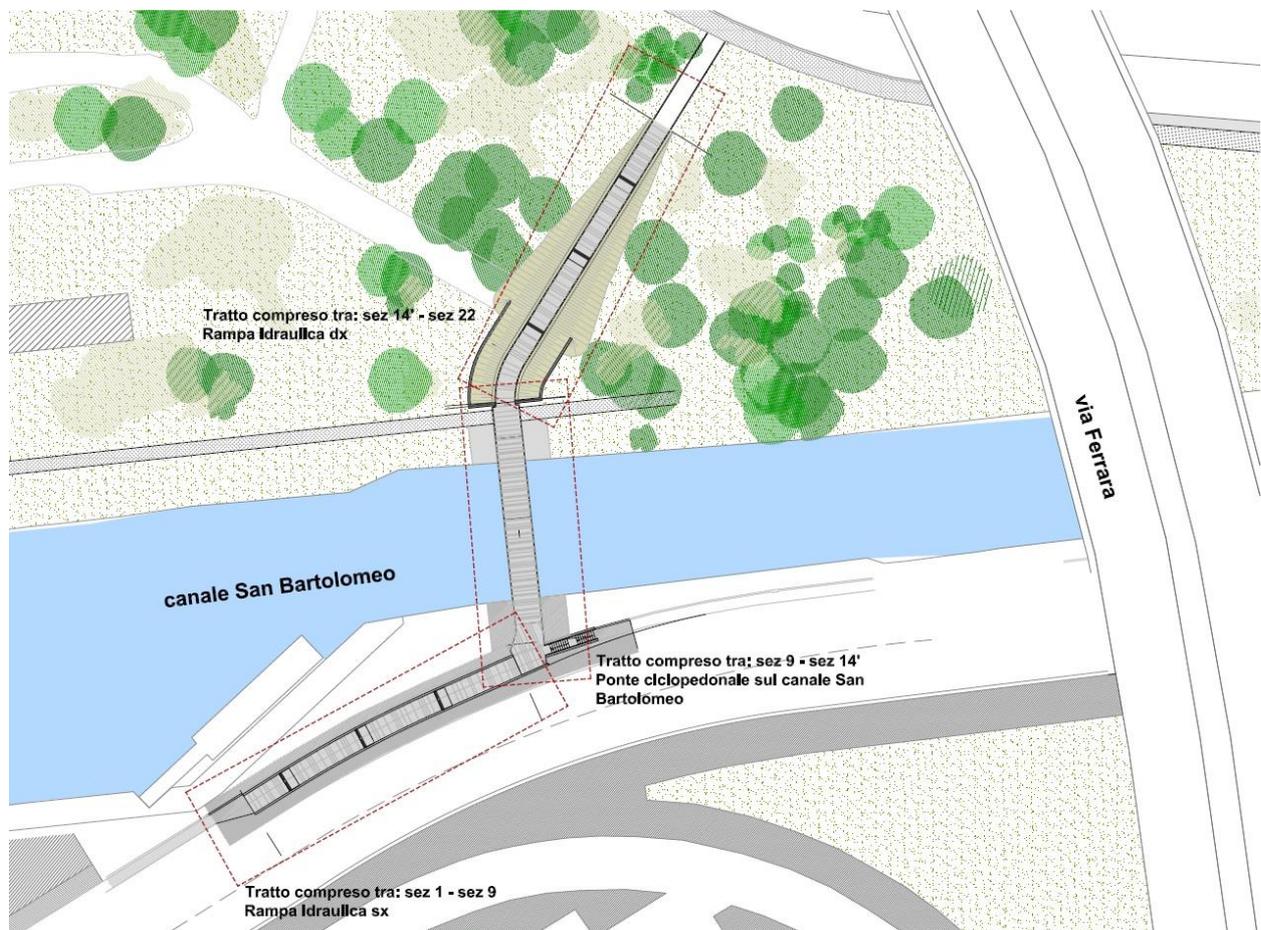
Schema degli interventi previsti nel progetto esecutivo - Planimetria
